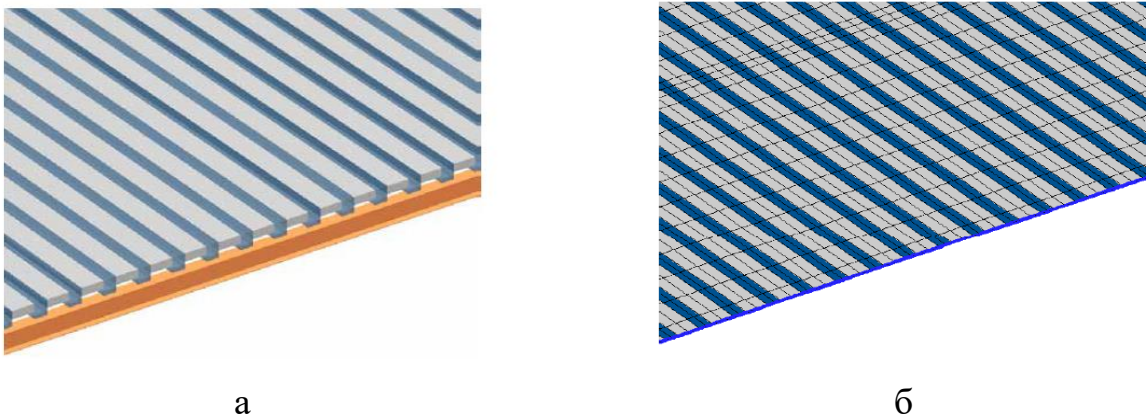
Вариант компоновки расчётной схемы сталежелезобетонного перекрытия с плитами, устроенными по несъемной опалубке [70]
